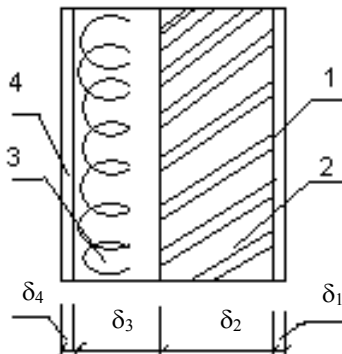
К примеру определения толщины утепляющего слоя наружной стены
